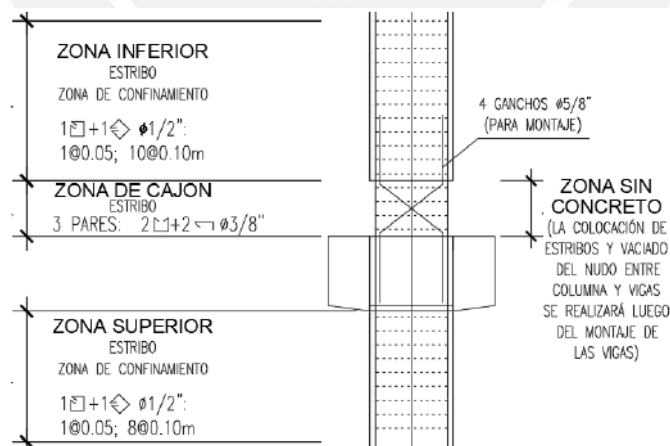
Detalle de zona de cajón. Conexión columna – columna.
